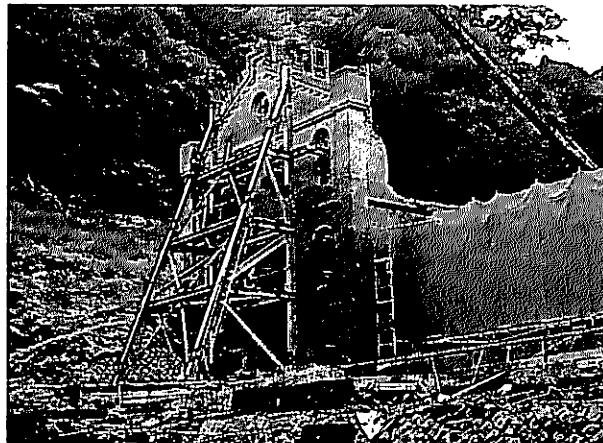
配電盤室鉄骨トラス組バットレス施工状況
